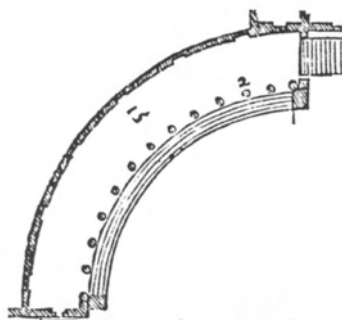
Ala de serviço em curva, Villa Trissino. Fonte: Palladio, 1570.
